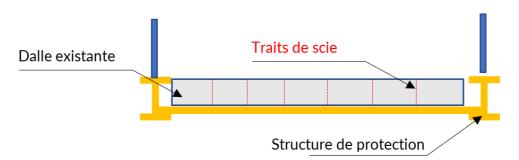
coupe transversale de la structure de protection phase travaux - Variante 1
